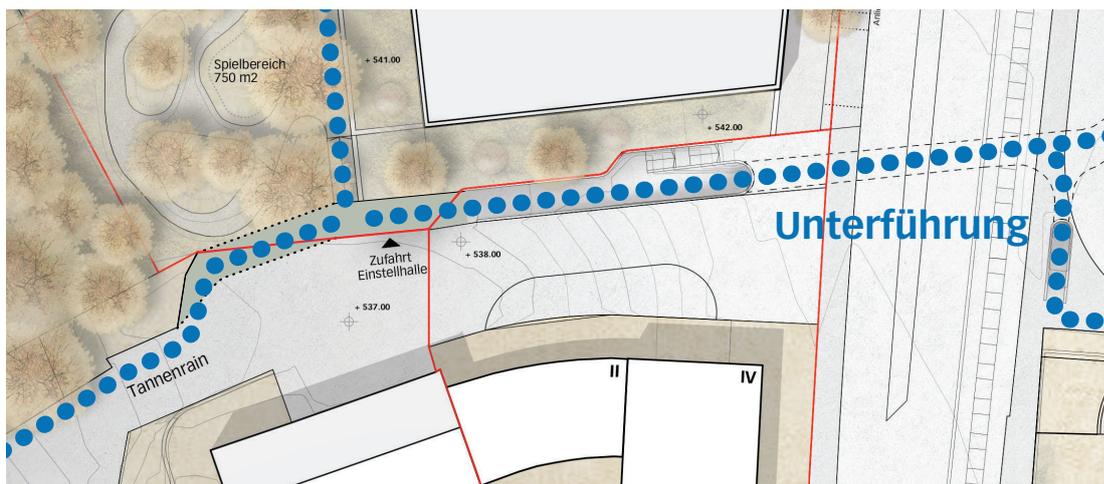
Situation Tannenrain: Fussgängerführung und Zufahrt Einstellhalle
